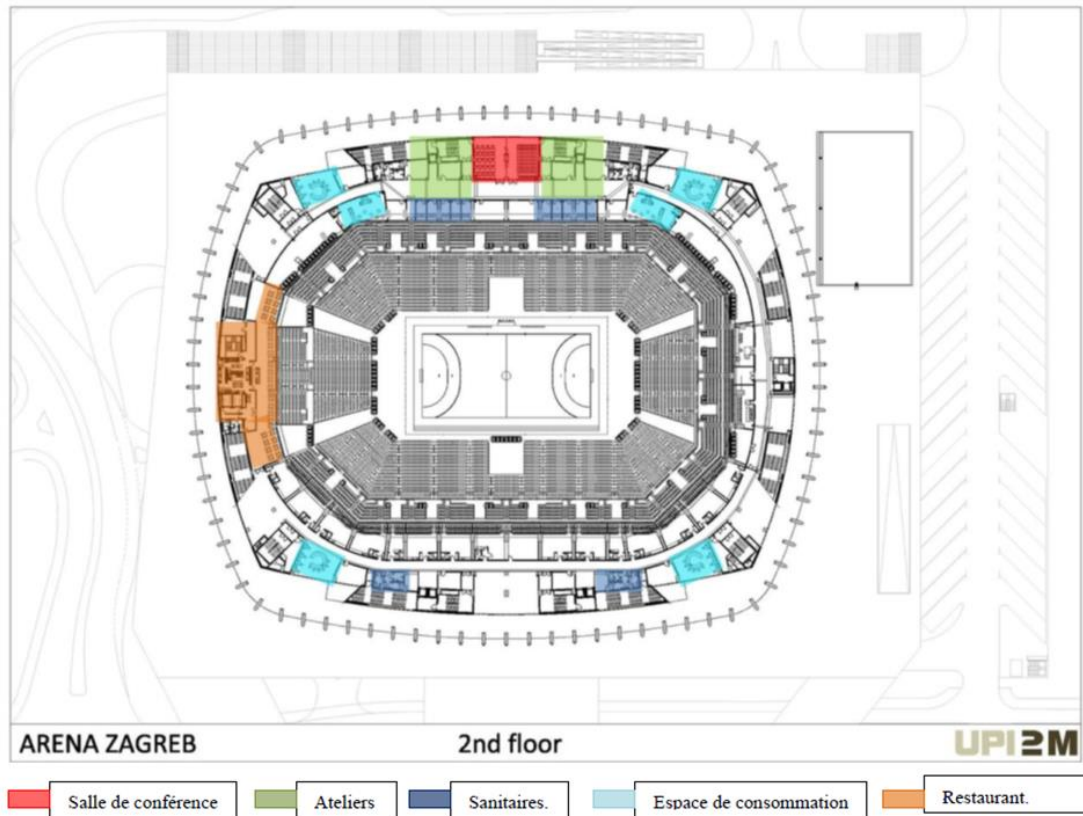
Plan du 2eme étage, Arena, Zagreb, Croatie.
